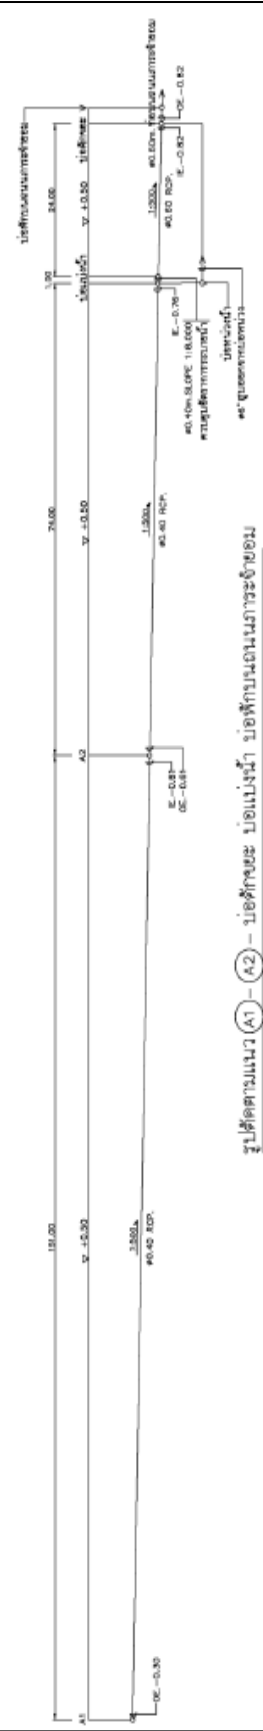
แบบขยายบ่อพัก (Manhole) และบ่อดักขยะ (Inspection Pit)
